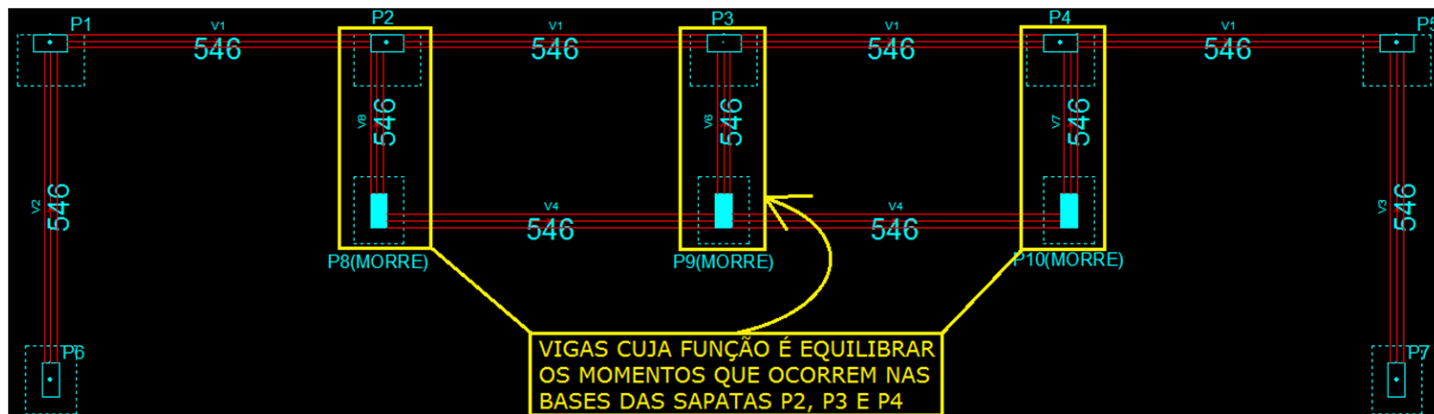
Novo lançamento do pavimento “ Térreo ”
